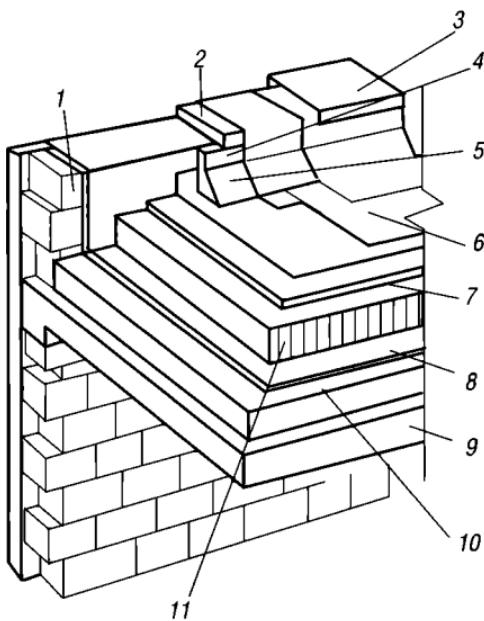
Конструкция невентилируемой бесчердачной крыши:
